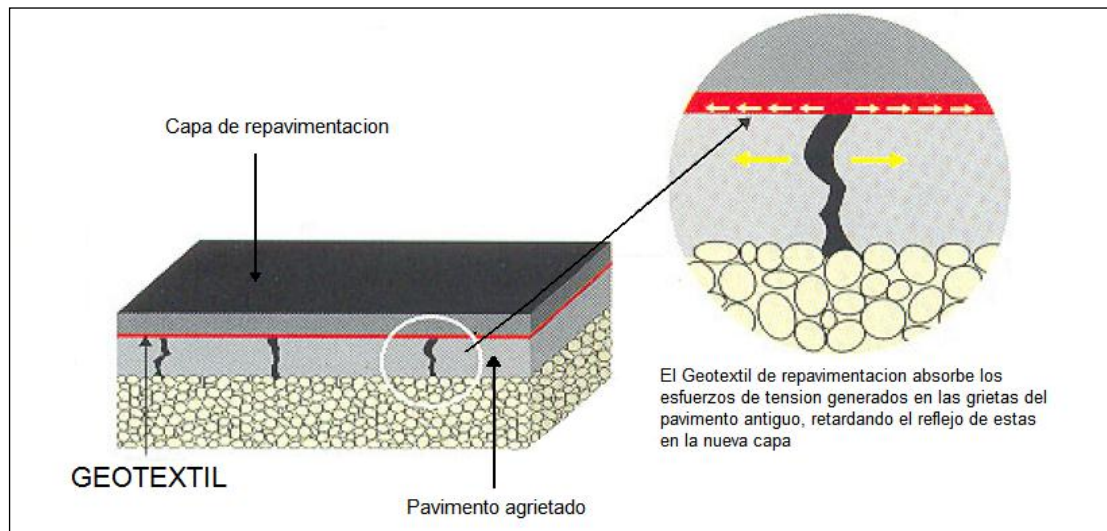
Conformación de la estructura del pavimento con geotextil.
